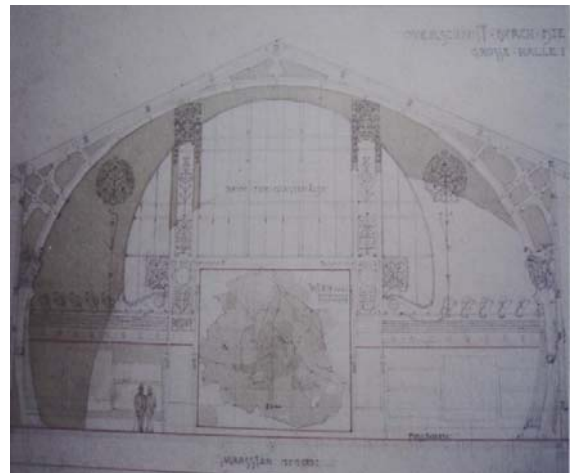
Olbrich: Querschnitt durch die große Halle, Jubiläumspavillon, 1897
